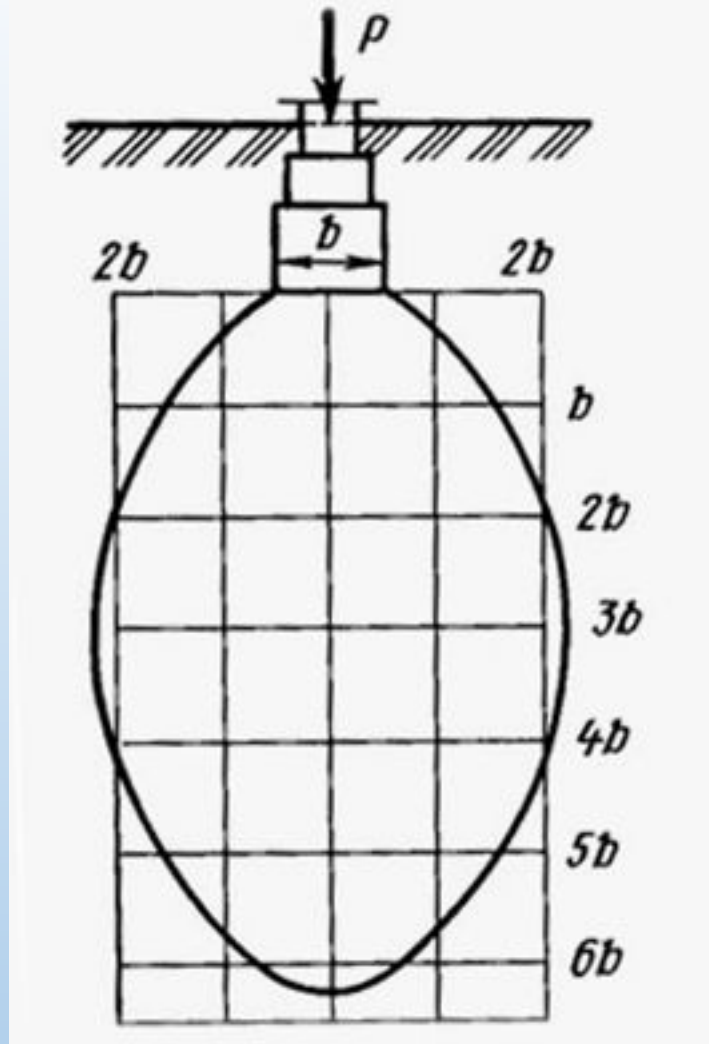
Напряженная зона грунта основания под подошвой фундамента:
